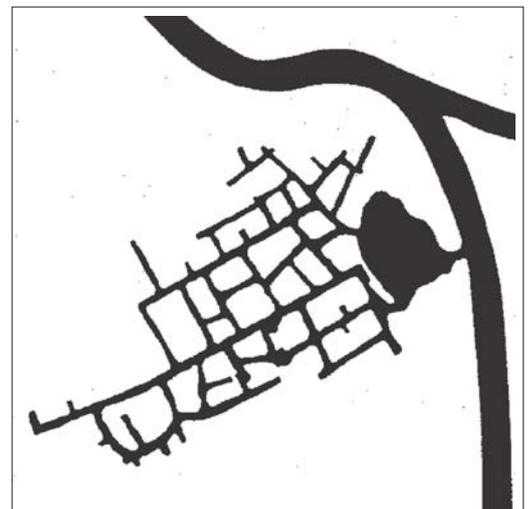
Planimetria della rete caveale delle Fosse Ardeatine
